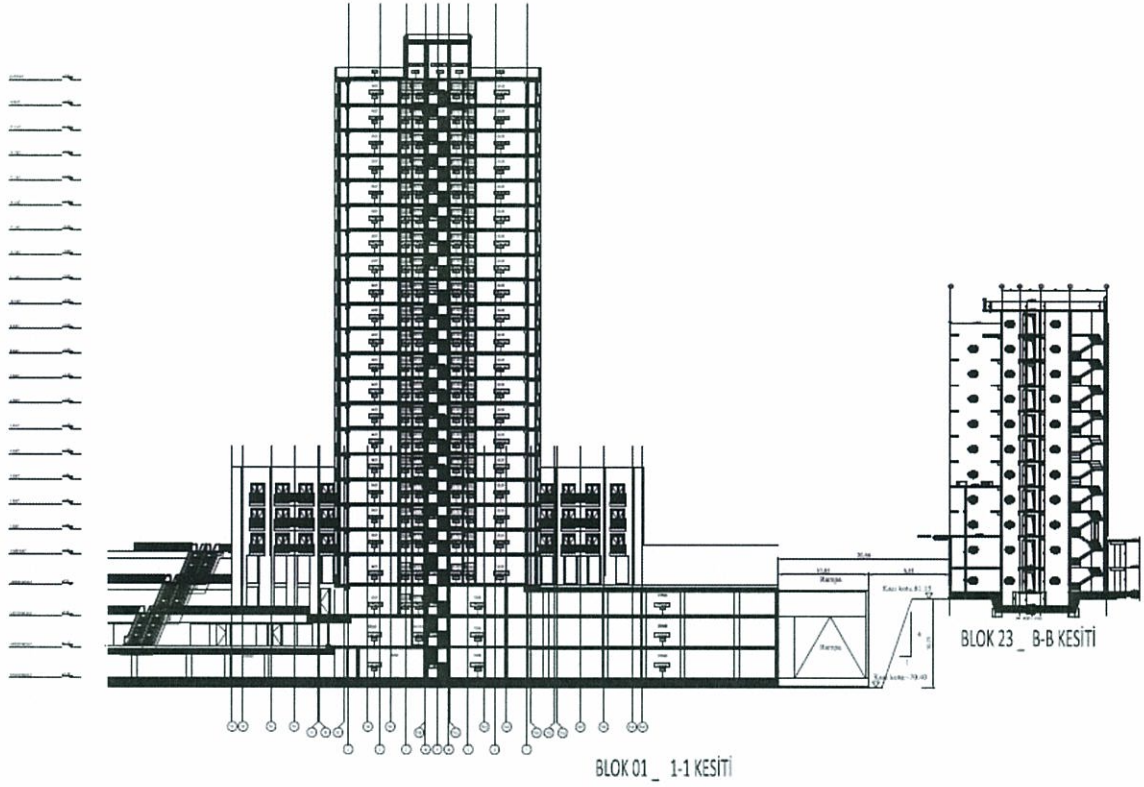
B01-B – B22-B ve B23 Blok plan görünümü (I-I' Kesiti ve II-II' Kesiti)
